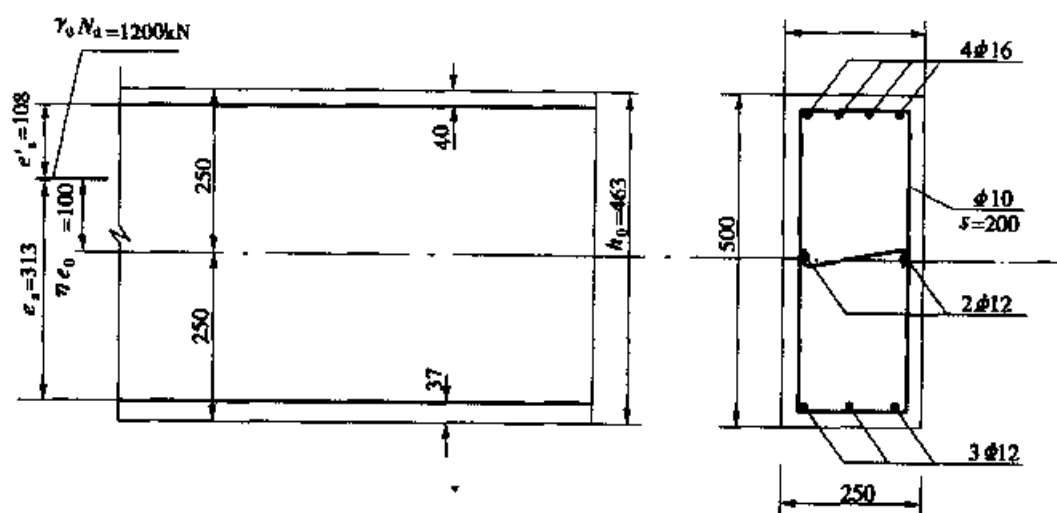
偏心受压构件计算简图及配筋(尺寸单位:mm)
